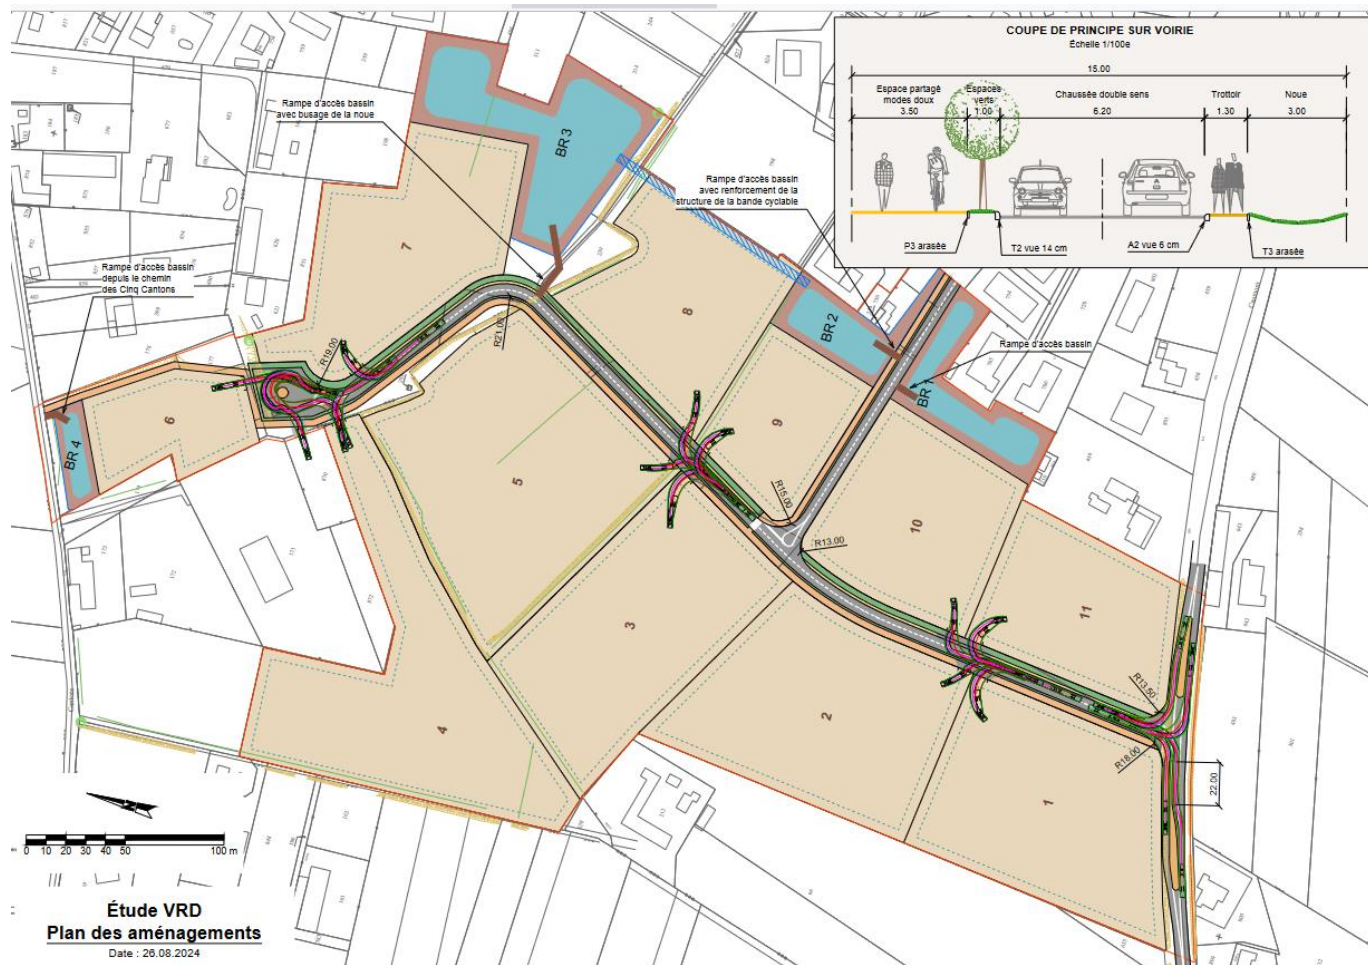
Implantation et spatialisation du projet (source : Cyclade)
